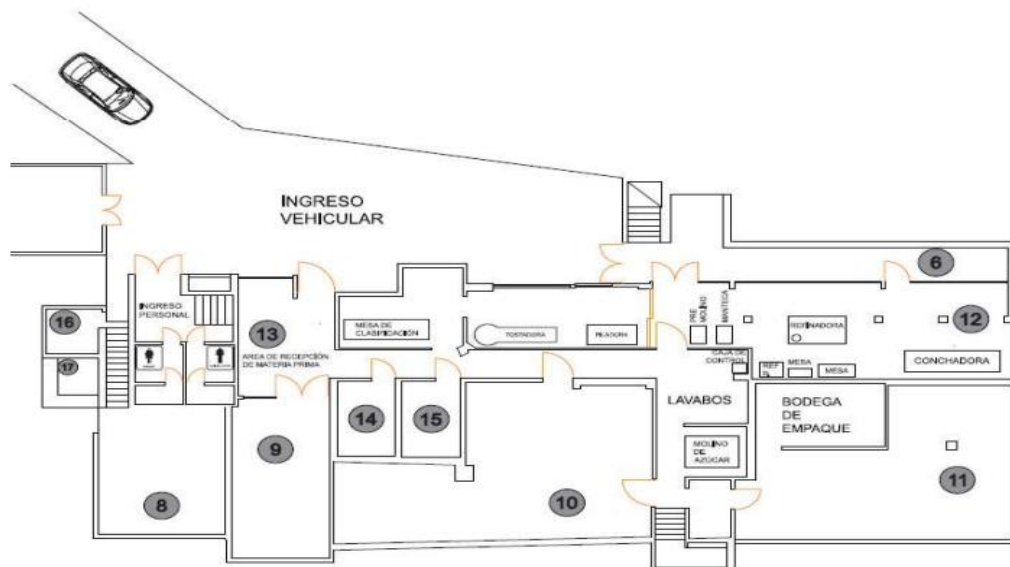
Plano Fábrica de Confites El Salinerito 2022 Planta Baja
